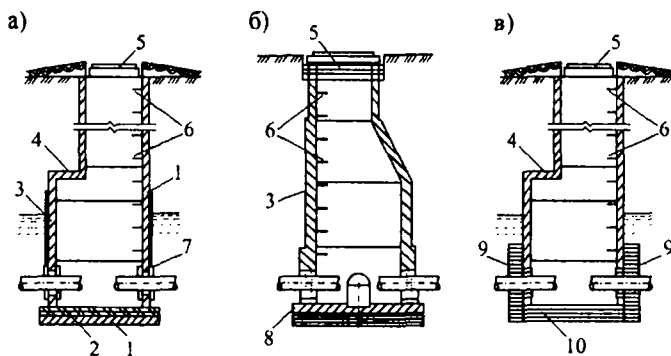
Сборный круглый (а, б) и прямоугольный (в) железобетонные колодцы, устраиваемые в грунтах:
